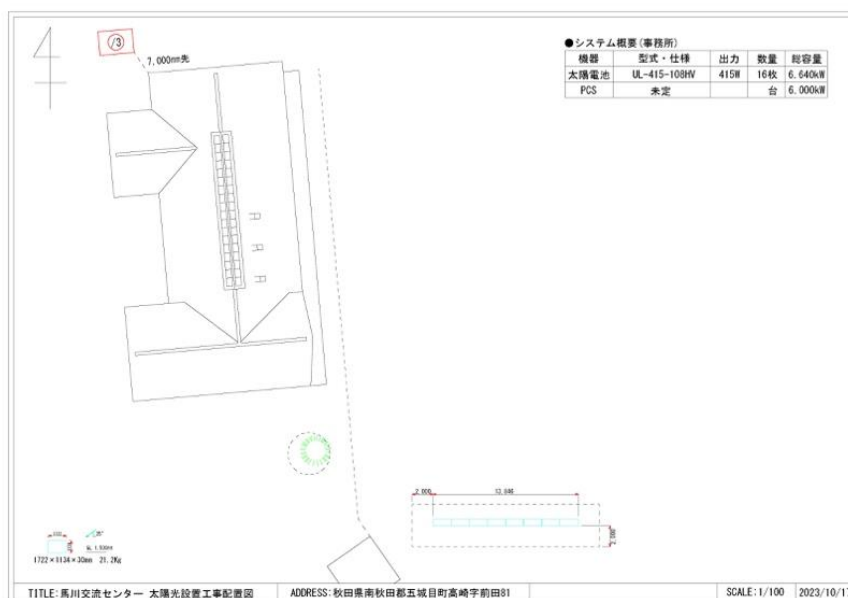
馬川交流センター 太陽光設置工事配置図
